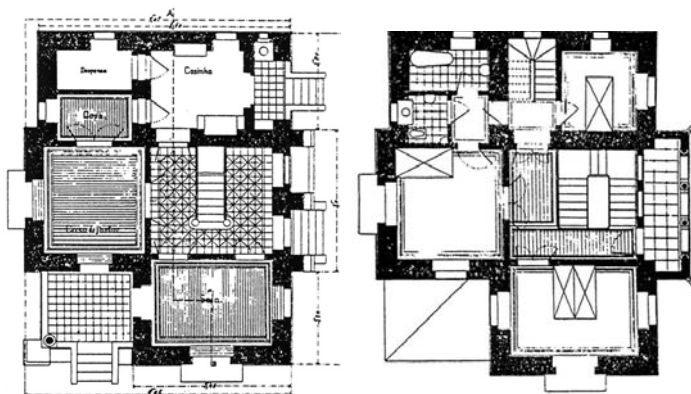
Casa para o Sr. General Oliveira Gomes – Plantas do rés-do-chão e do primeiro andar.
